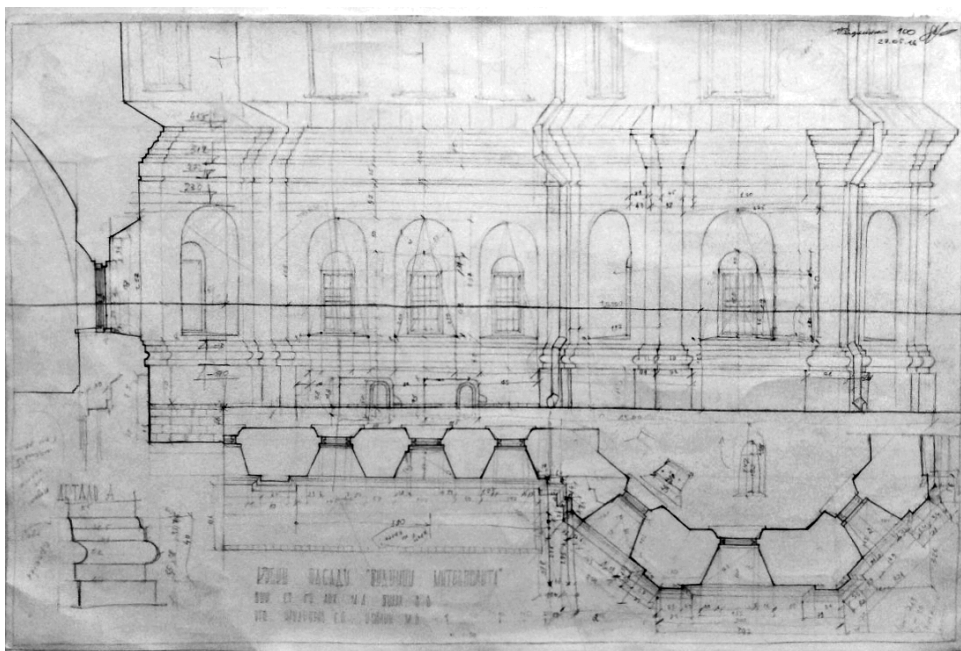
Креслення фрагменту східного фасаду будинку митрополита (вик. ст. Булах В.В.).
